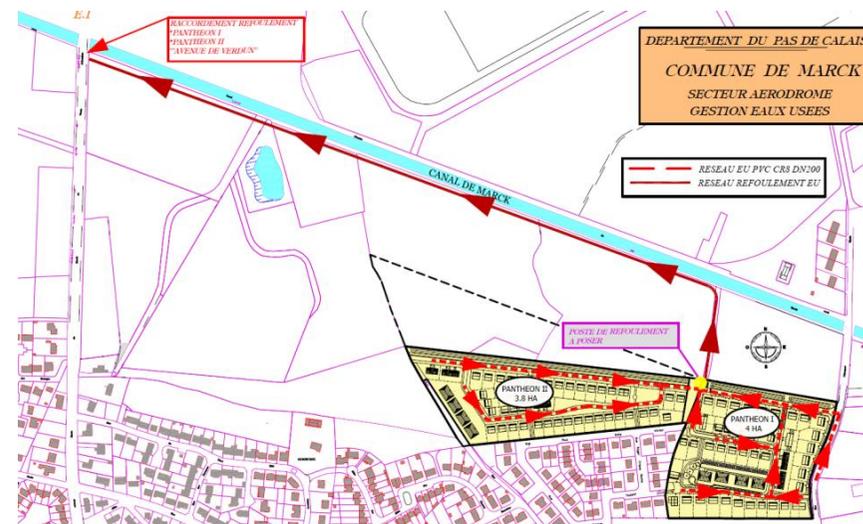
Plan d'assainissement / Gestion des eaux usées
